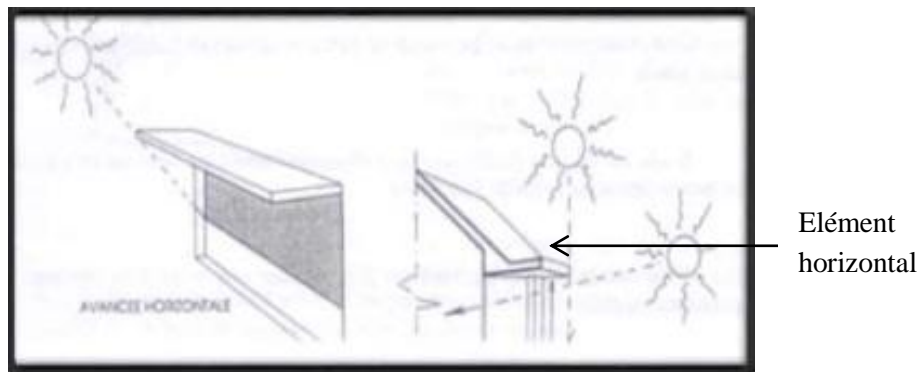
AVANCEE HORIZONTALE - Façade sud
